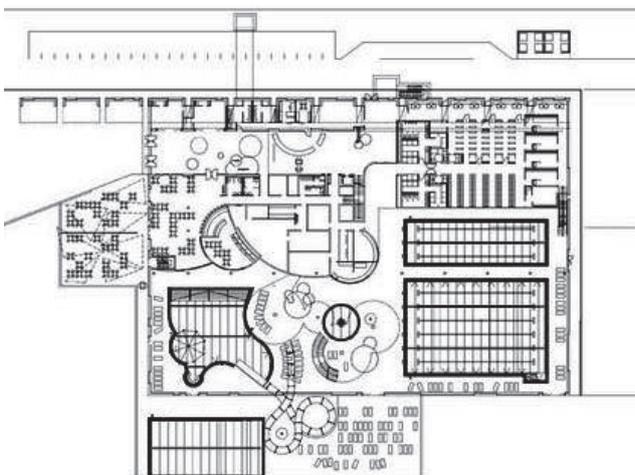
Grundriss Ebene 00 - Drautalperle
